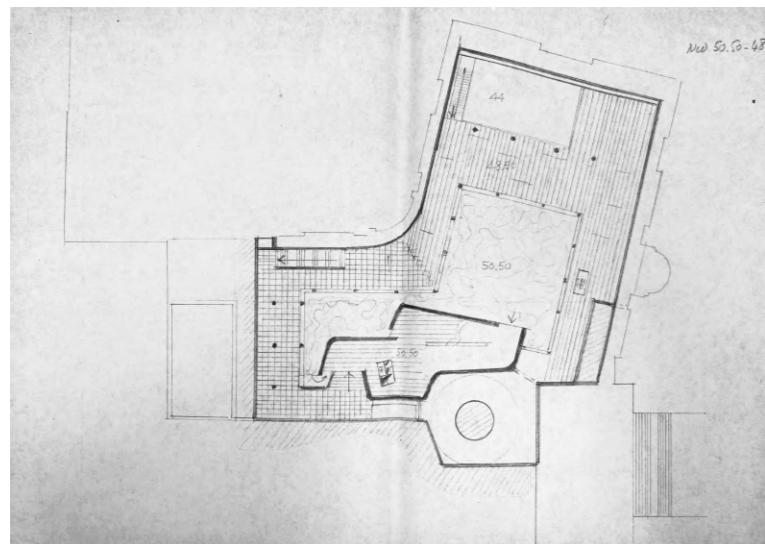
Plan R-2, 7^{ème} esquisse.
